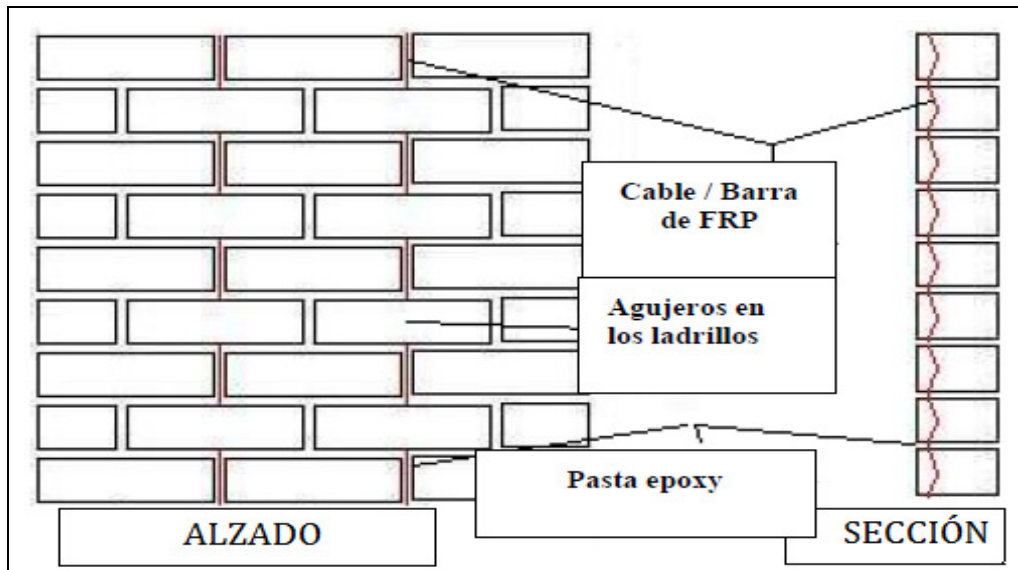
Ejemplo de refuerzo vertical en un muro mediante cable.
